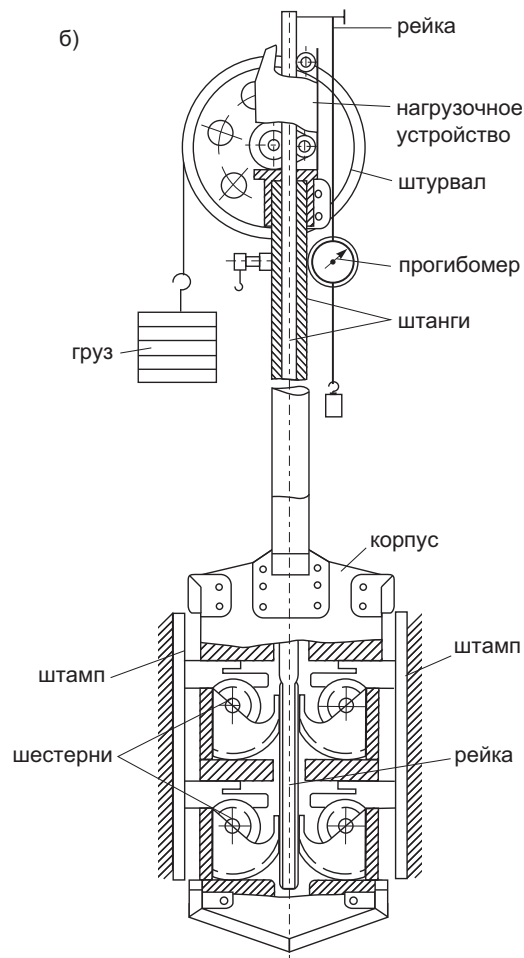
Прессиометры, разработанные в ПНИИСе: а — ЛП-14С; б — ЛП-12М [6]: 1 — груз; 2 — штамп; 3 — шестерни; 4 — рейка; 5 — нагрузочное устройство; 6 — штурвал; 7 — прогибомер; 8 — штанги; 9 — корпус; 10 — штамп; 11 — рейка
